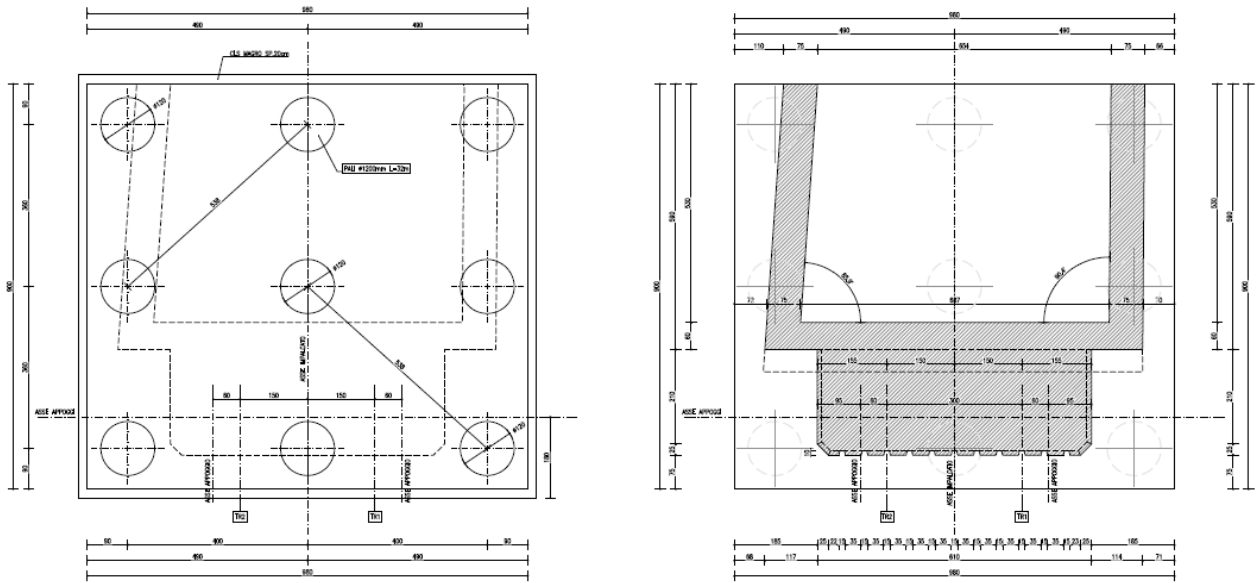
Spalla 2 – carpenteria fondazioni
